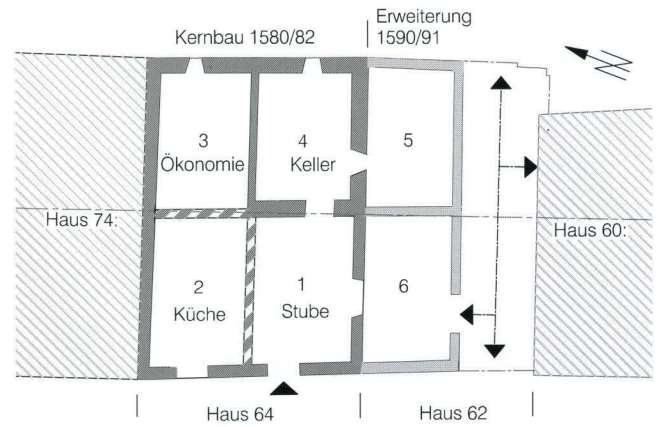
Obere Dorfstrasse 62/64. Grundriss mit Rekonstruktion. – Zeichnung: Hans Ritzmann.
